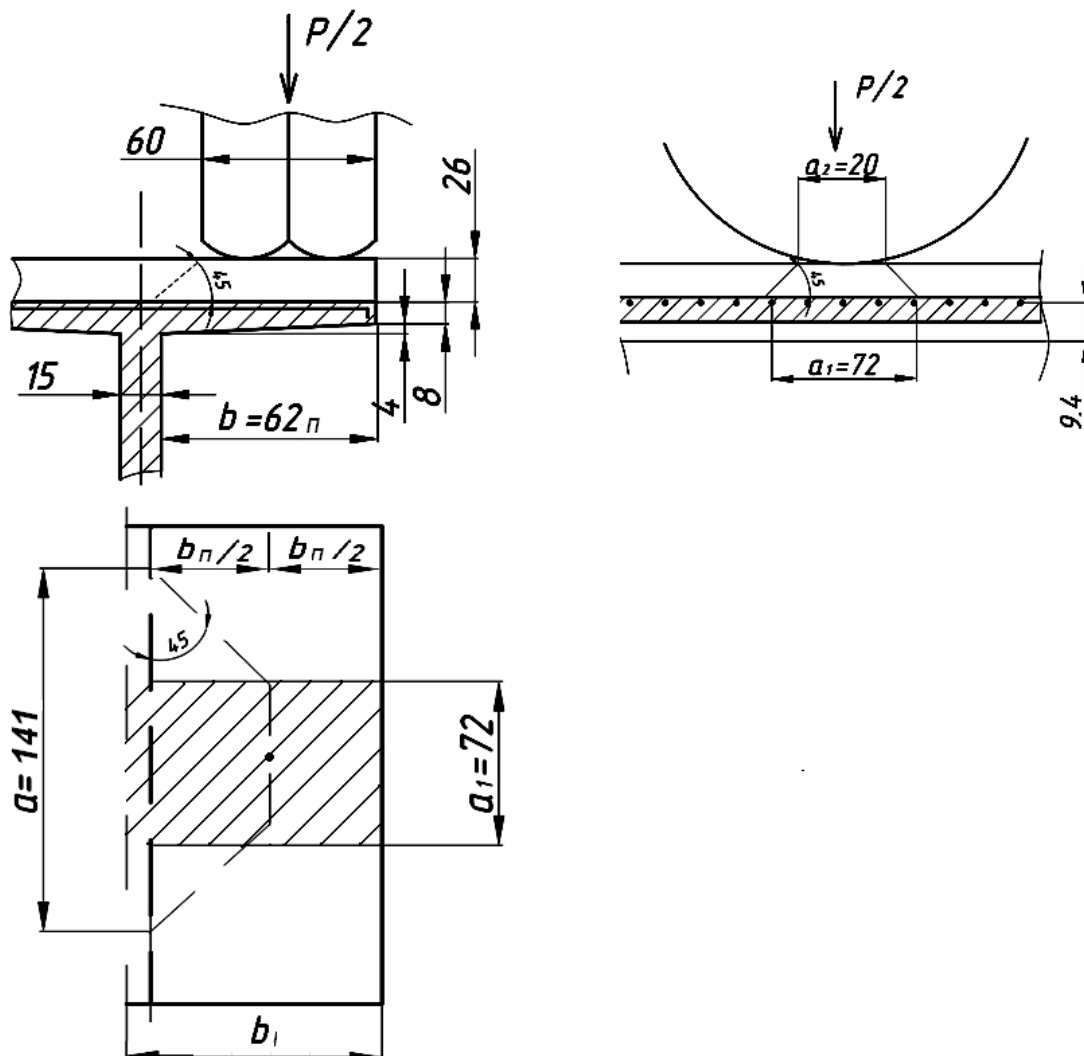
Схема определения грузоподъемности консольной плиты проезжей части
